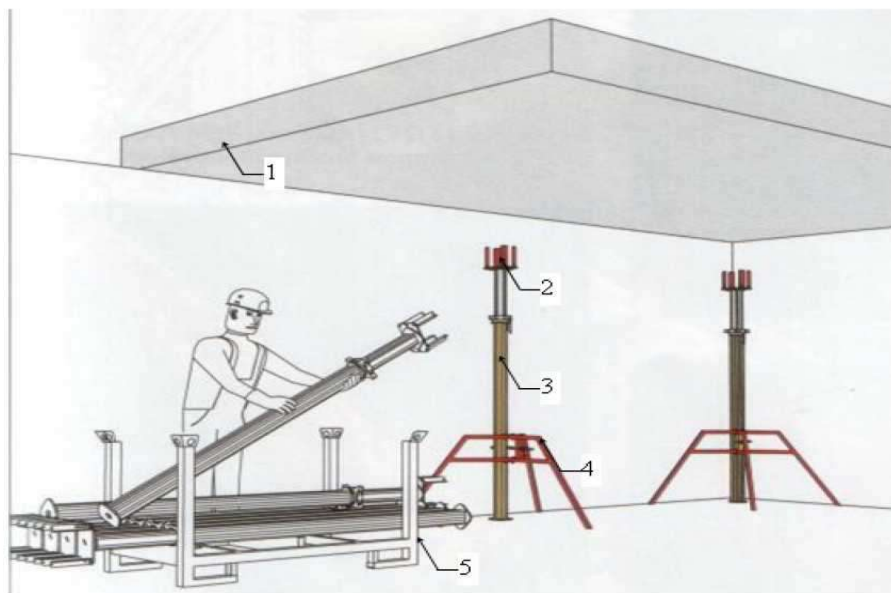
Демонтаж основных стоек: 1 - вновь возведенное перекрытие; 2 - унивилка; 3 - стойка; 4 - тренога; 5 - контейнер для складирования элементов опалубки
